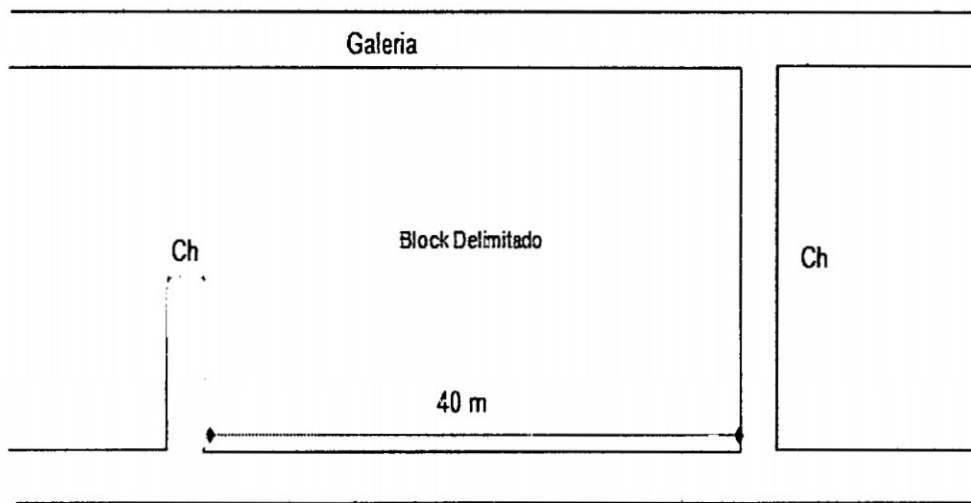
vista transversal de un block delimitado indicando chimeneas
